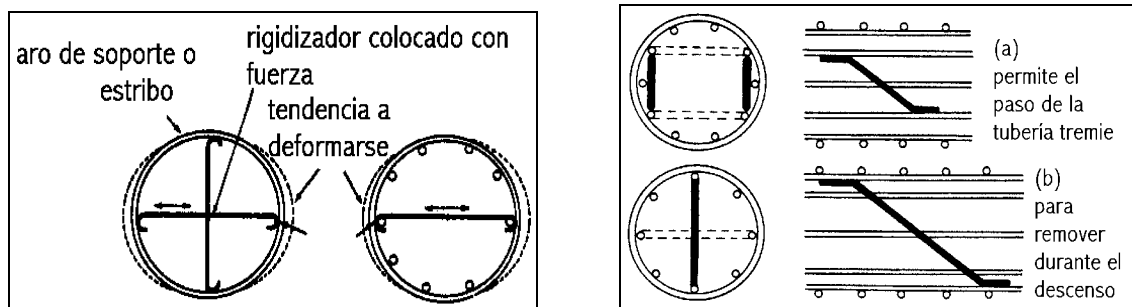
, RIGIDIZADORES EN ARMADOS DE PILAS (LCPC, 1986)
